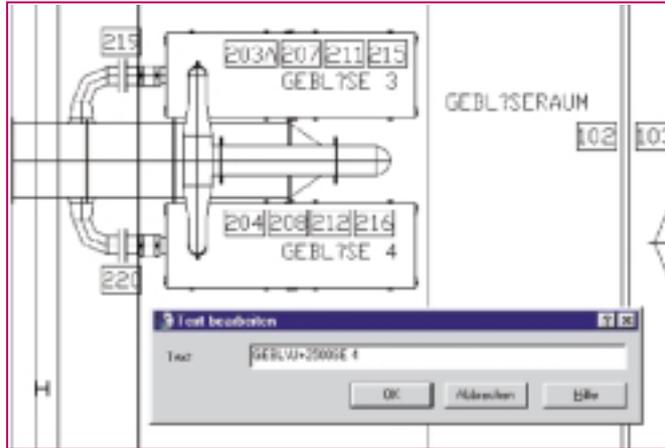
Schlechtes Aushängeschild: Plan mit falsch dargestellten Umlauten
